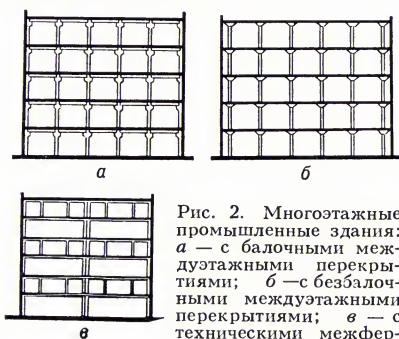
Многоэтажные промышленные здания: а — с балочными междуэтажными перекрытиями; б — с безбалочными междуэтажными перекрытиями; в — с техническими межферменными этажами.
